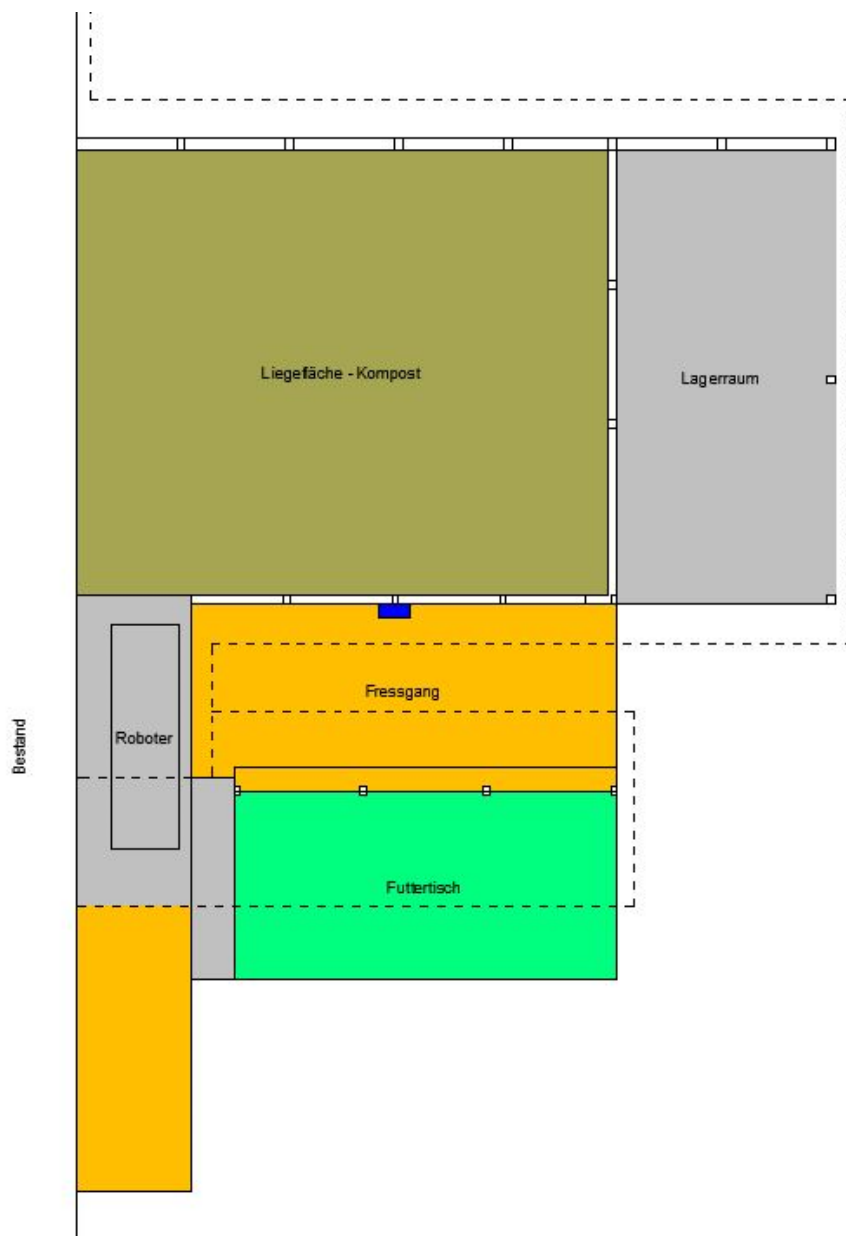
Grundriss eines Kompoststalles mit AMS (Zeichnung: B. Rudorfer, LFZ Raumberg-Gumpenstein)
